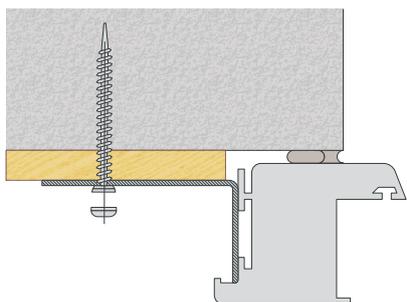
Exemple d'assemblage entre menuiserie et son support structural (4)
